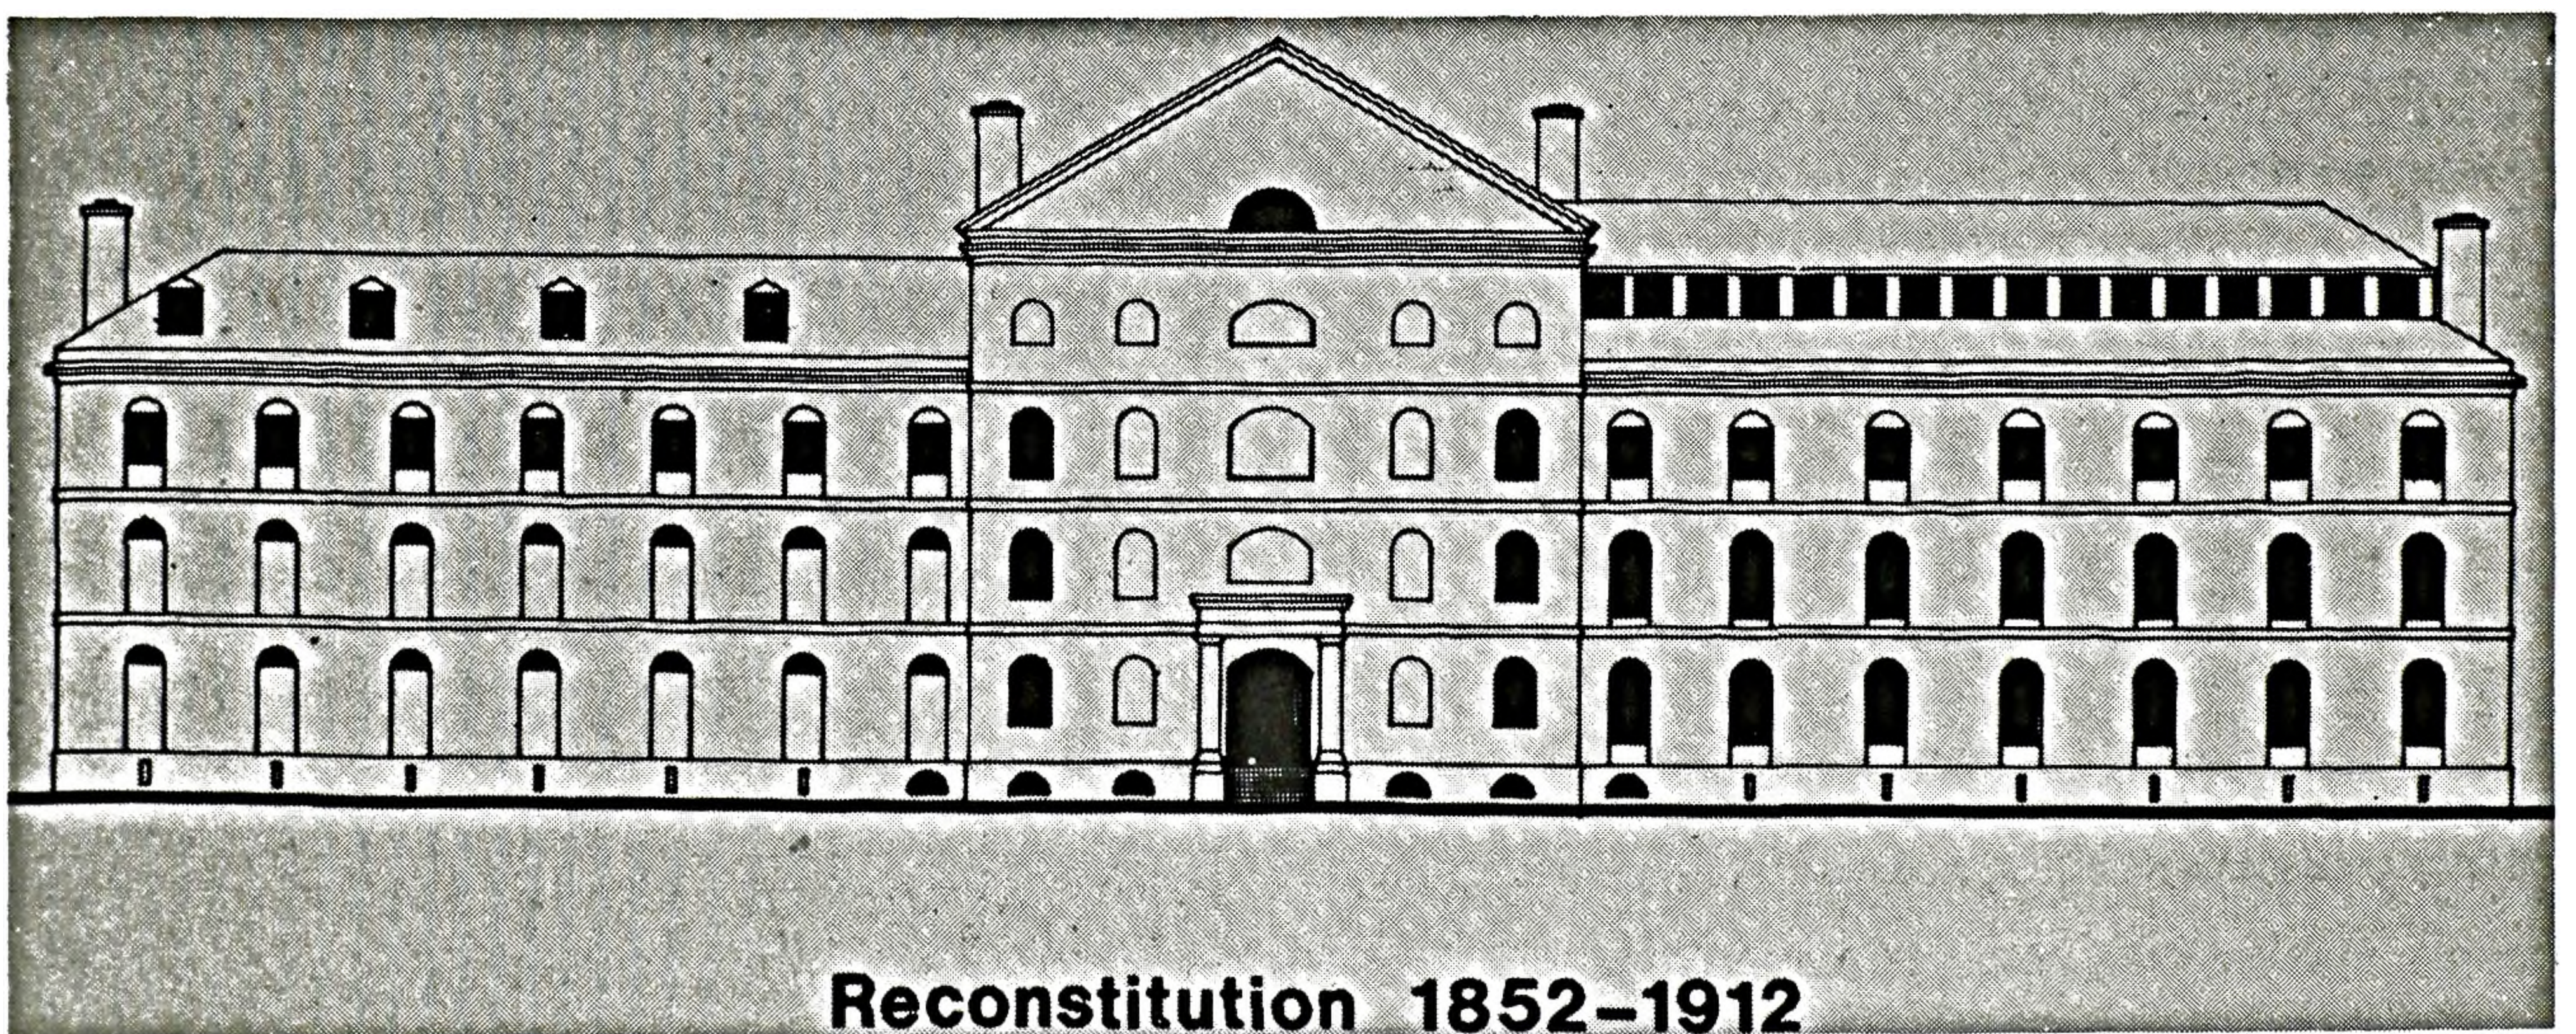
Reconstitution de la façade de la prison du Pied-du-Courant, de 1852 à 1912. (Dessin de Pierre d'Anjou).
